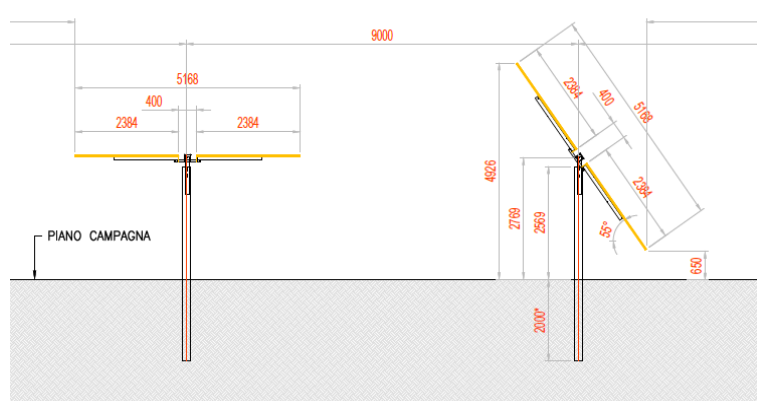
Particolare strutture di sostegno moduli, sezione trasversale.
